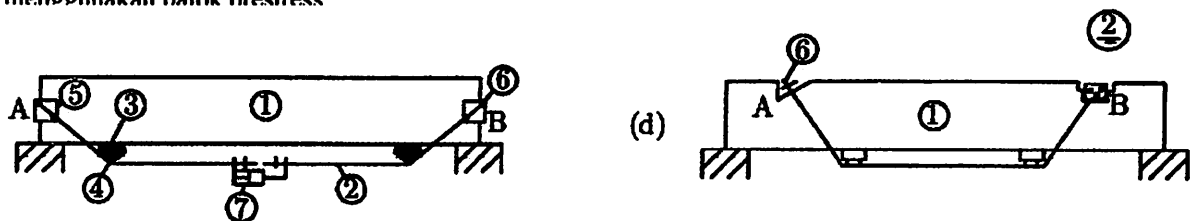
Perkuatan balok-kolom beton dengan pelat baja
